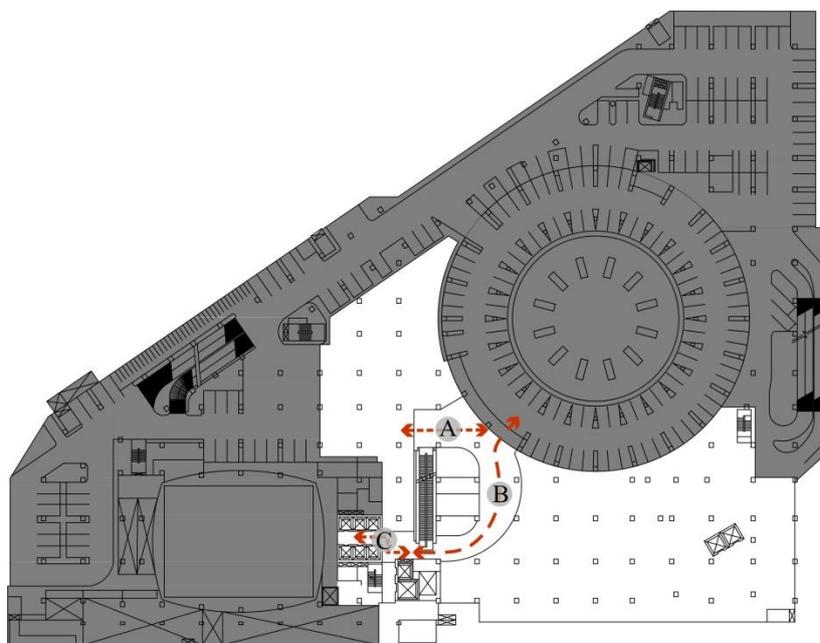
Alur Sirkulasi Ruang pada 5<sup>th</sup> Floor Plaza Semanggi
